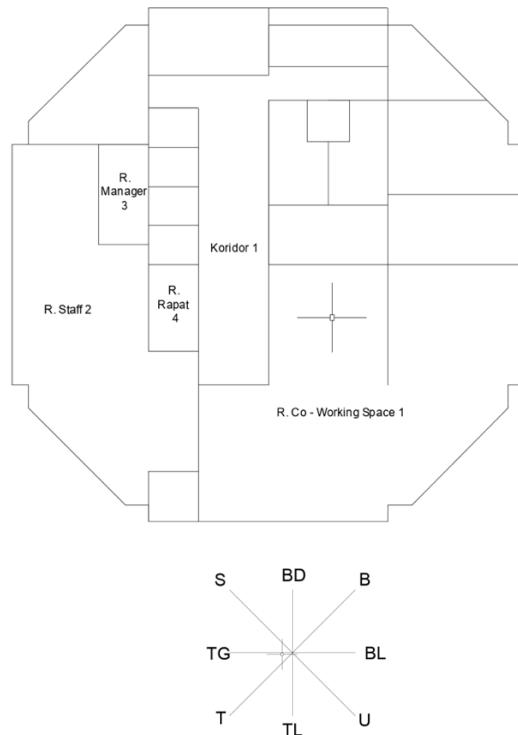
Denah Lantai 1 Gedung Perkantoran PT. P Surabaya
